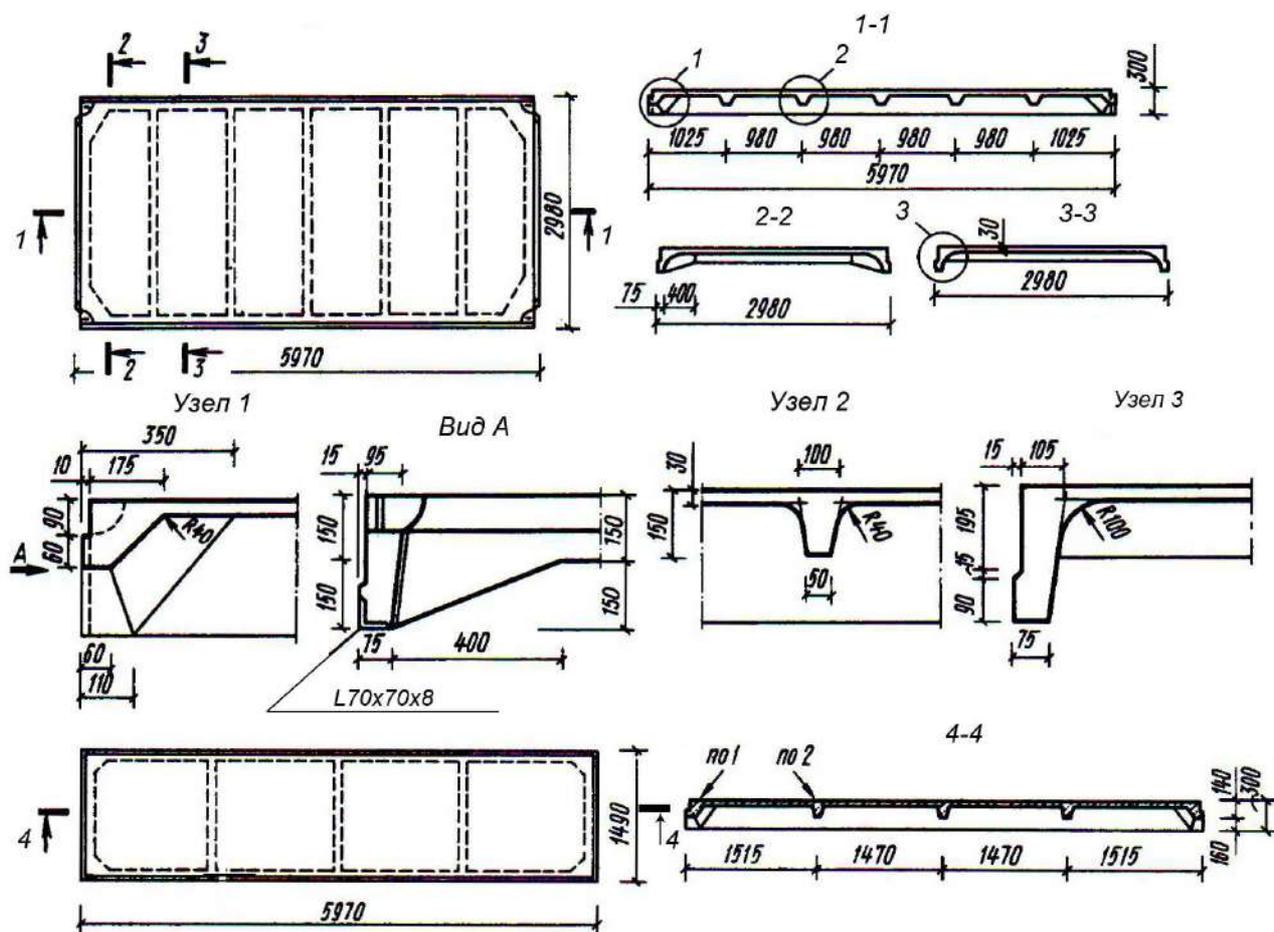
Плиты железобетонные ребристые размером 6,0 × 3,0м и 6,0 × 1,5м для покрытий производственных зданий
